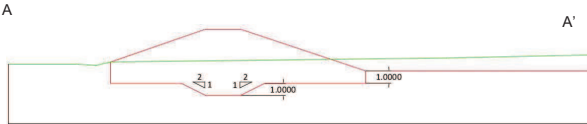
coupe de principe de l'ancrage de l'ouvrage
